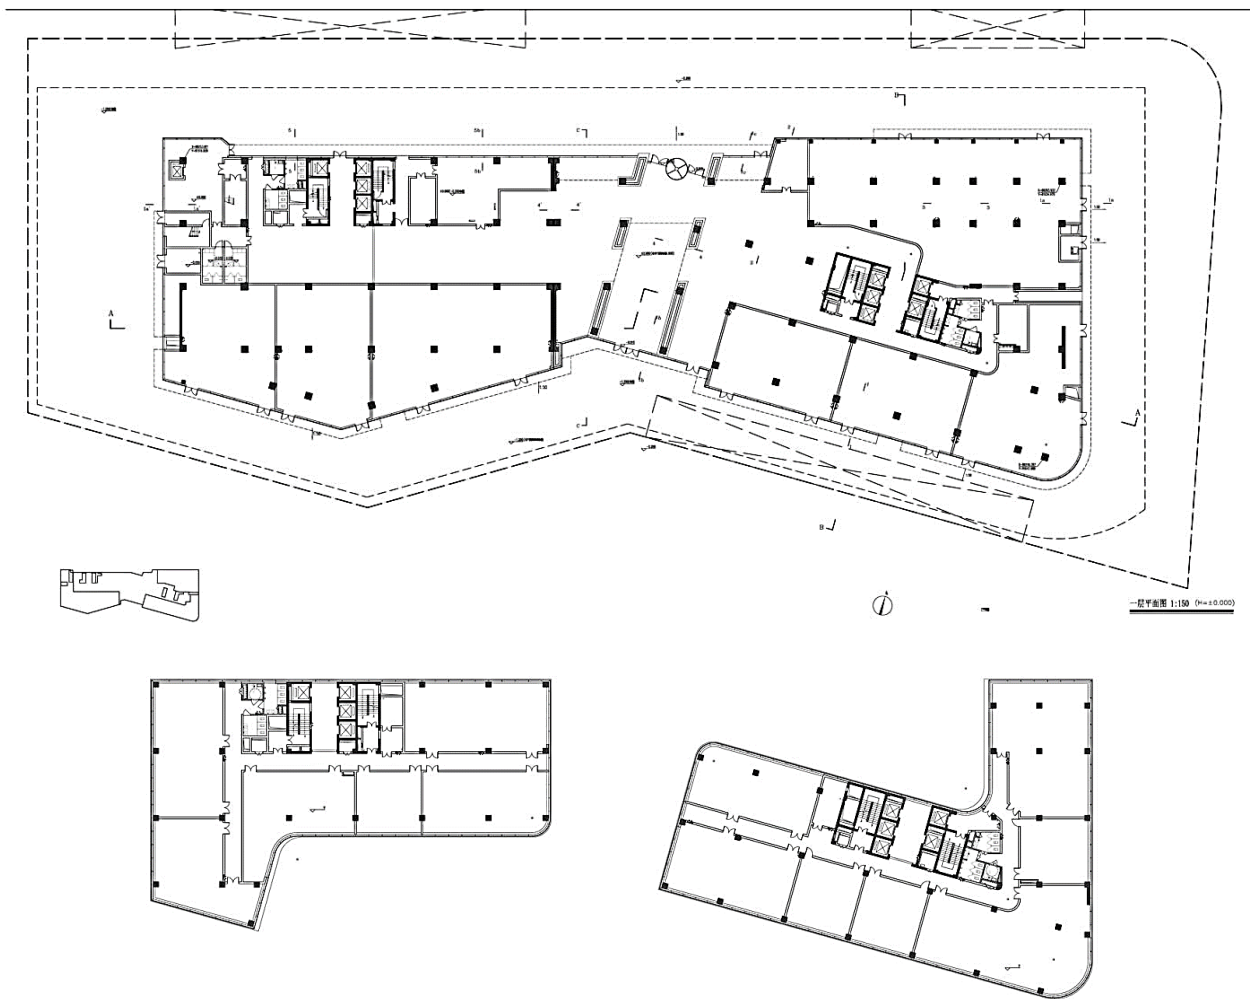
Планування типових поверхів Бізнес-центру New World
